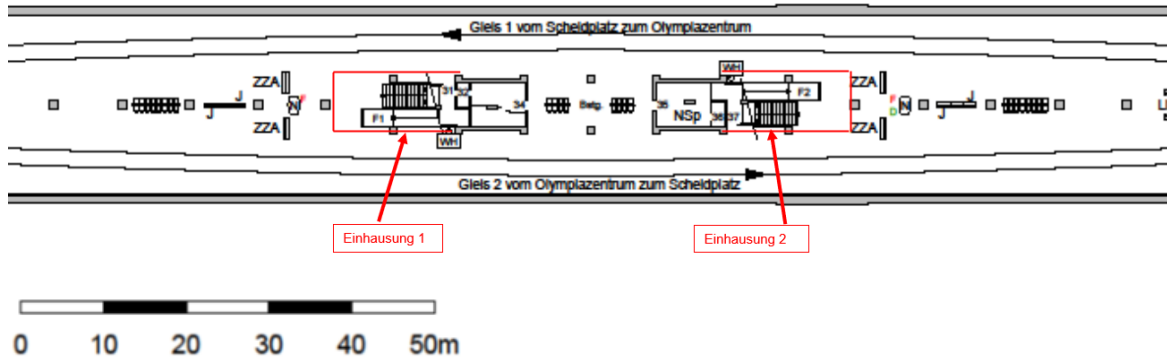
Grundriss Bahnsteiggeschoss, Einhausungen
